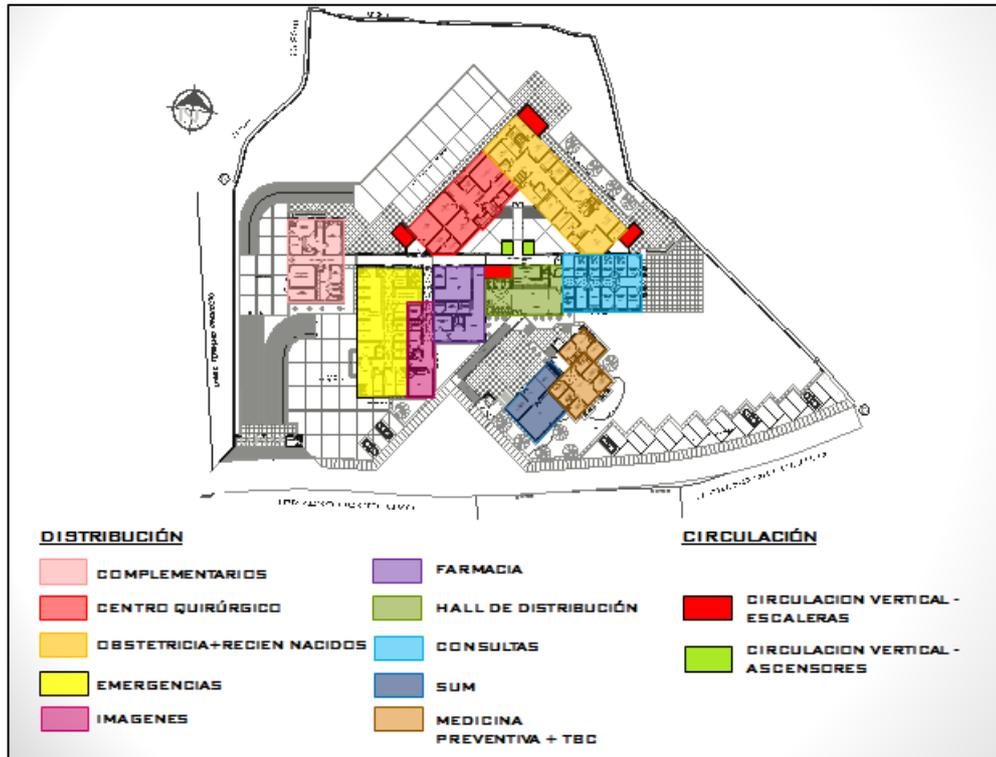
Plano Primer Nivel Hospital II-1 Cajabamba
